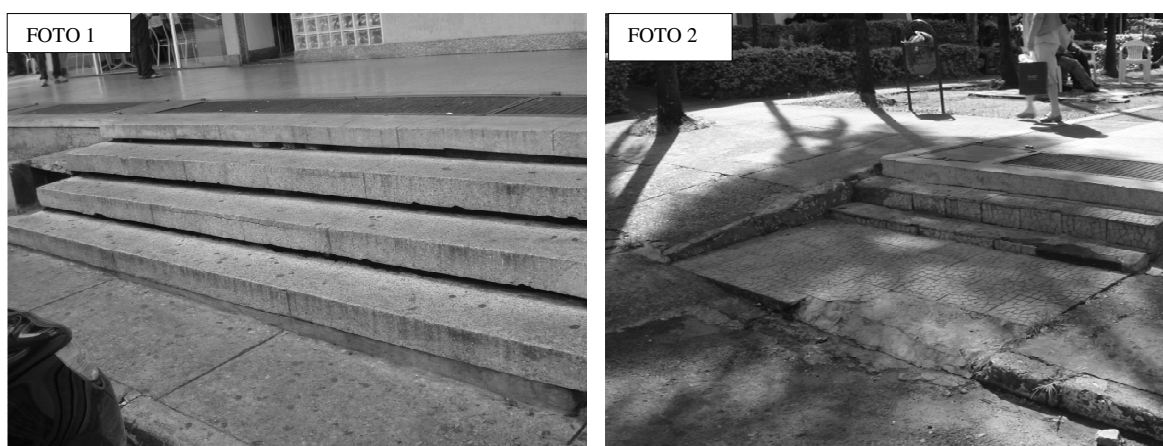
Foto 1, Escada 106NBE1 ao Bloco B; Foto 2, Escada 106NBE2 ao Bloco B
